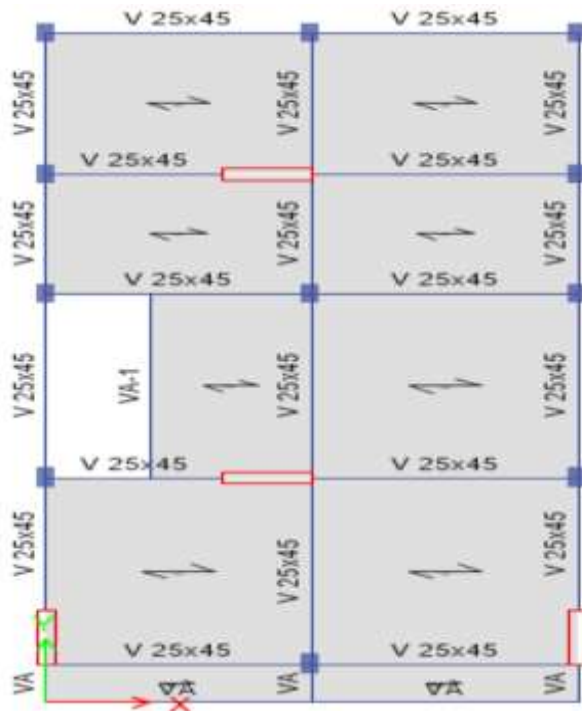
Concreto Armado, vista de la planta típica del módulo analizado
